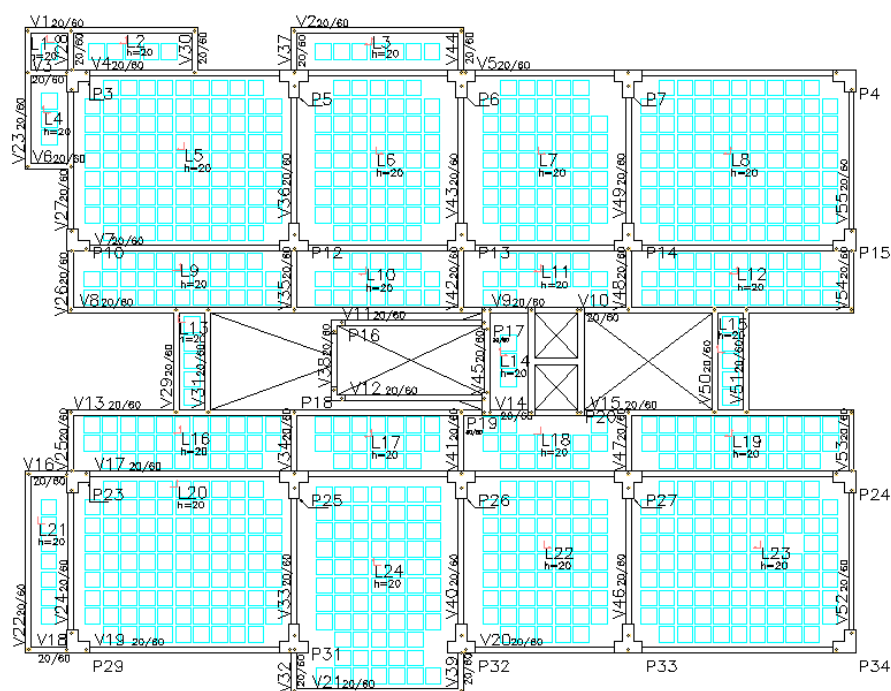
Desenho de fôrmas com cubetas do Pavimento PT5 da Solução com Laje Nervurada
